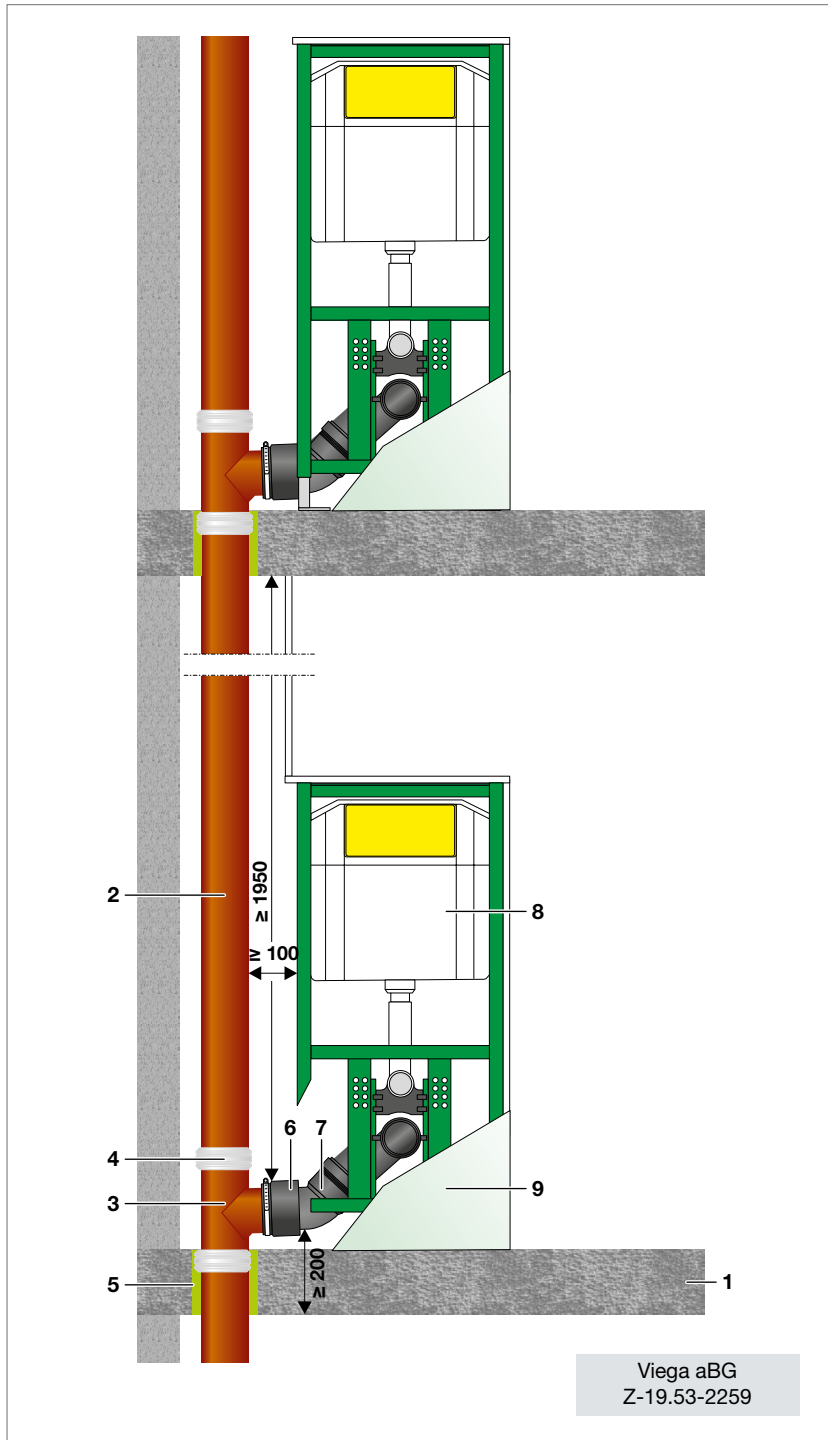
Aufbau Mischinstallation, „Viega Spülkästen mit Guss-Abflussleitungen“
